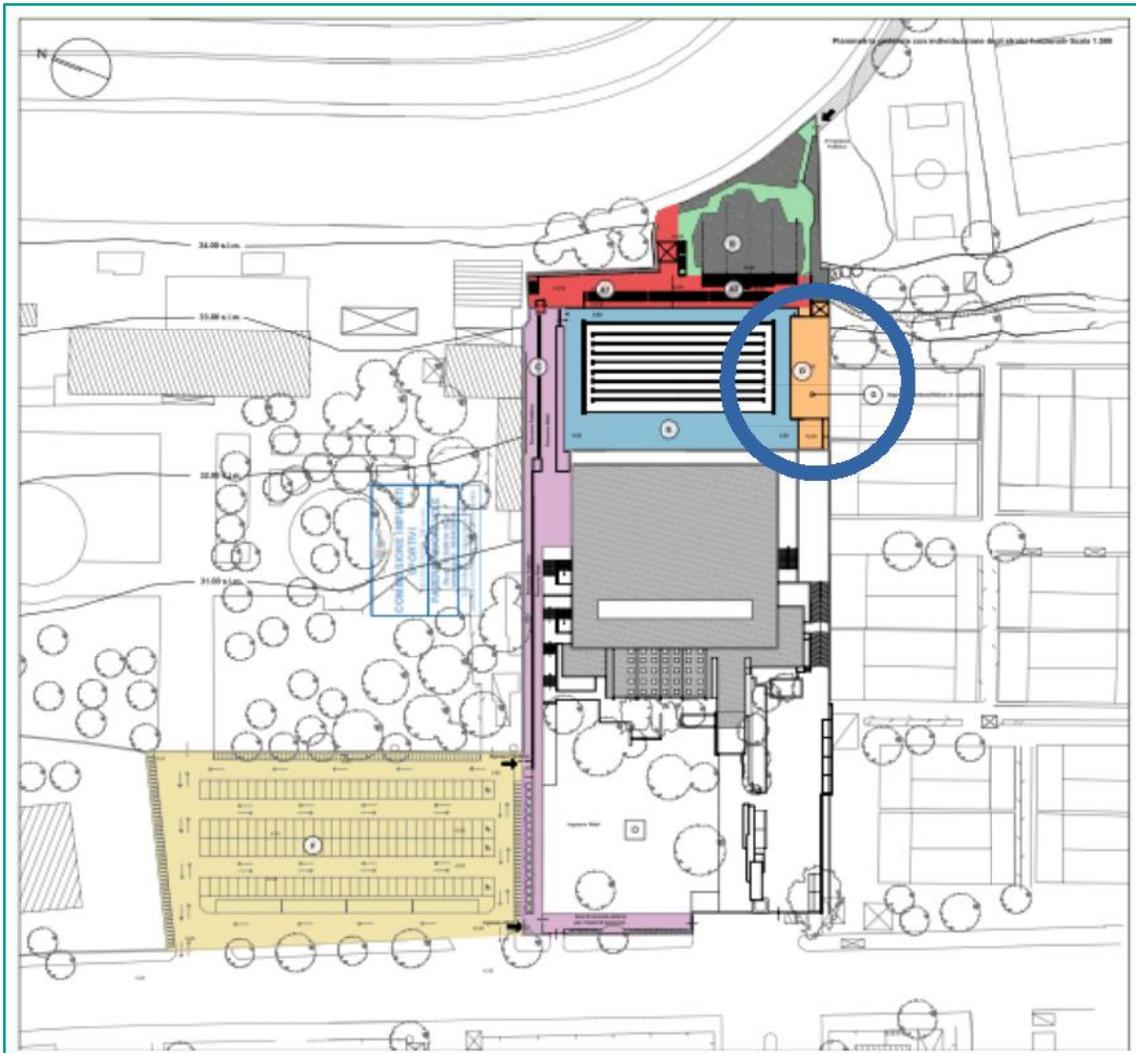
Planimetria di progetto generale ed evidenziazione del lotto
